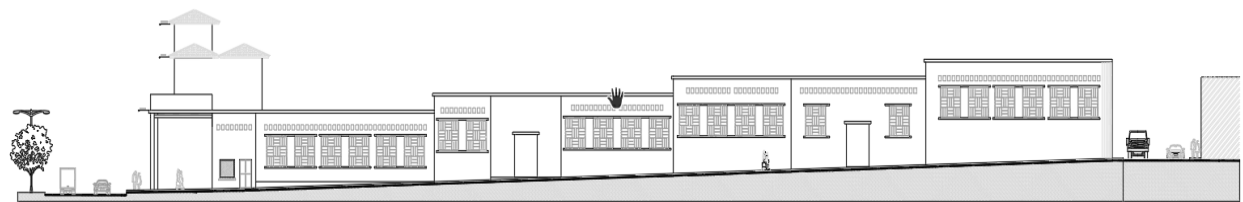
Fachada lateral plaza de mercado (Carrera 16). Adaptación Fachada 1949.
